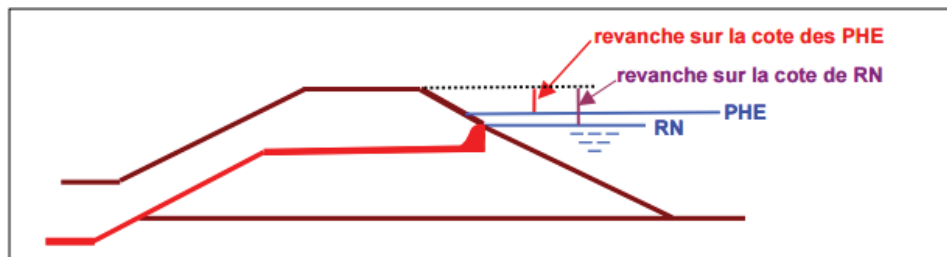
Revanche sur les PHE ou sur la RN pour un barrage non équipé d'un mur pare-vagues
